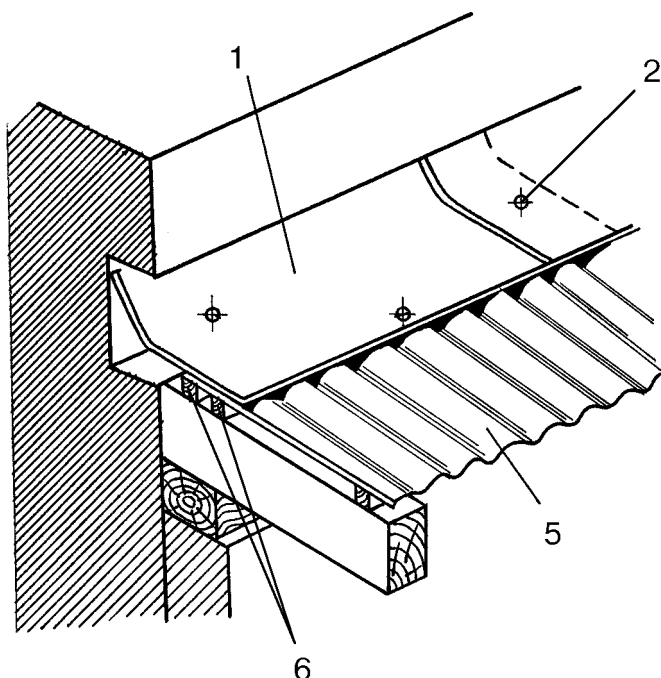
Поперечное примыкание ската шиферной кровли к стене
